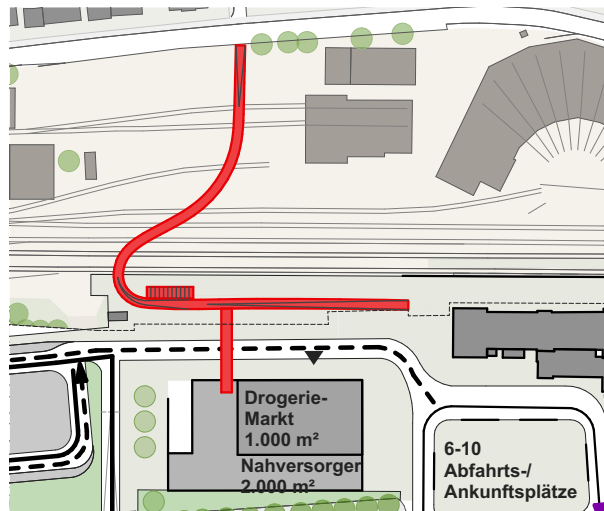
Brücke mit Schwung und Gebäudebrücke
